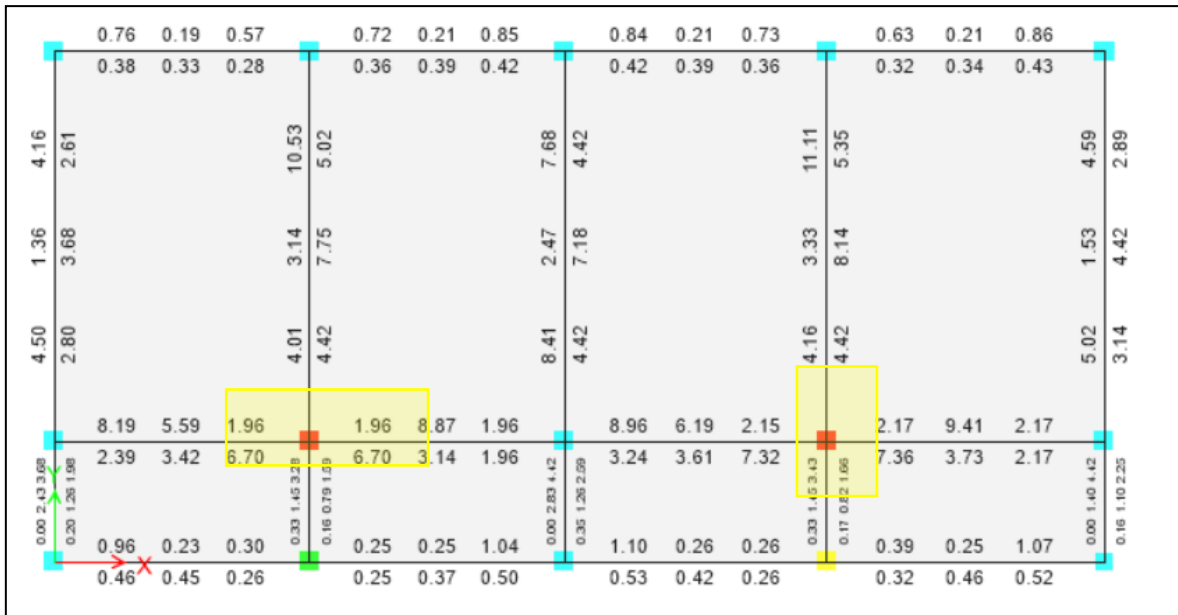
Vista en planta de segundo nivel de vigas y columnas del Pabellón A
